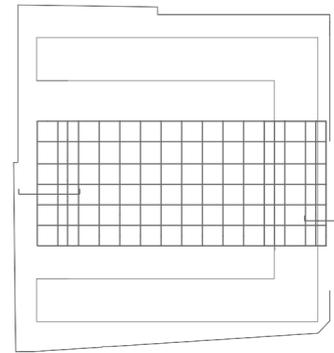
Escantillón de la fachada poniente. Fuente: Elaboración propia
